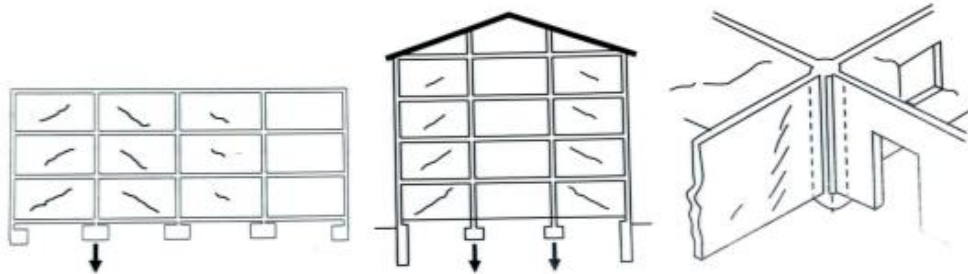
Exemplo de recalque de fundações de pilares internos (Fonte: Milititsky; Consolini; Schnaid, 2018).
